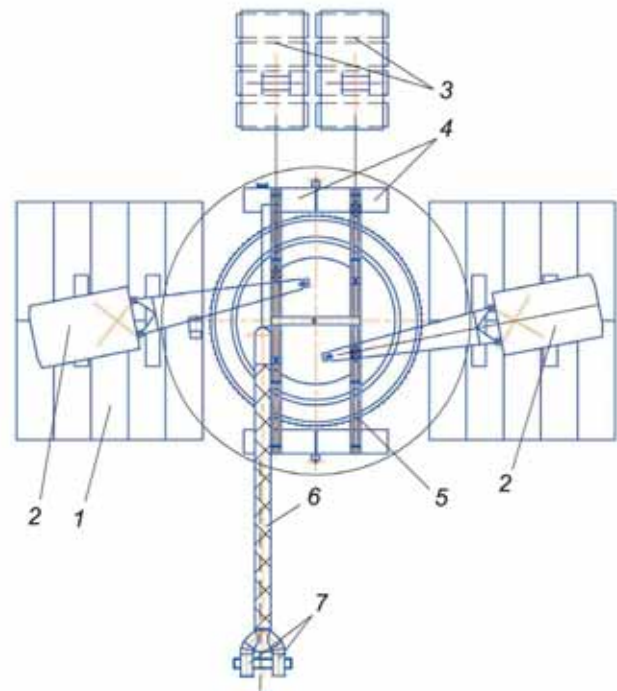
Расположение оборудования на поверхности: 1 – площадка под кран из железобетонных плит; 2 – краны МКГ-25БР; 3 – лебедки проходческие ЛПП-10; 4 – фундаментные блоки БФ-2; 5 – подшивные металлоконструкции; 6 – гибкий трубопровод; 7 – вентиляторы ВМ-6.
